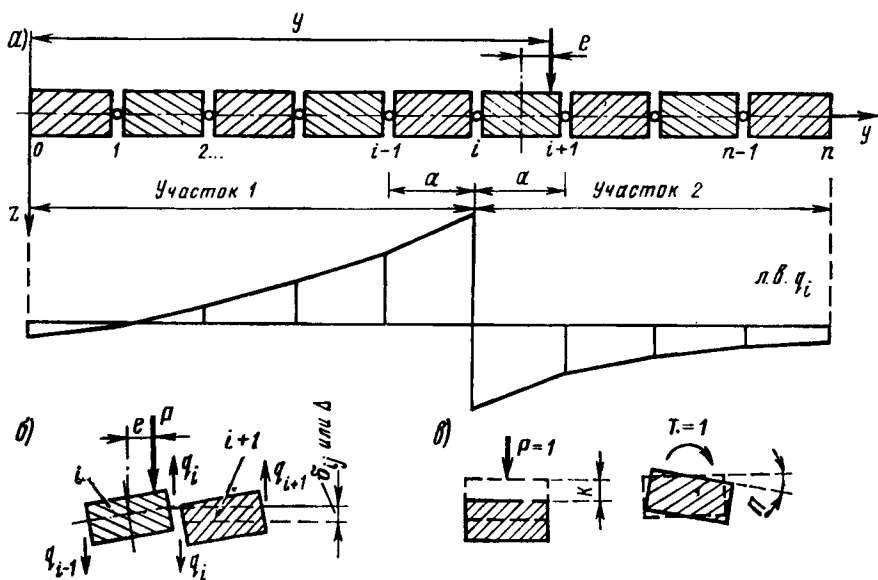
Схемы к расчету пролетных строений с шарнирными соединениями между несущими элементами
